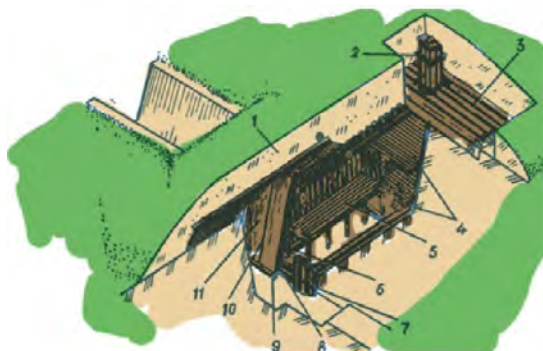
Бліндаж безврубної конструкції з лісоматеріалу на відділення (екіпаж): 1 – перекрита ділянка траншеї; 2 – вентиляційний короб; 3 – накат; 4 – нари; 5 – місце для сидіння; 6 – піч із місцевих матеріалів; 7 – стояк входу; 8 – дверний щит; 9 – привантажувальний елемент завіси; 10 – тяги з 2-міліметрового відпаленого дроту; 11 – герметизувальна завіса
